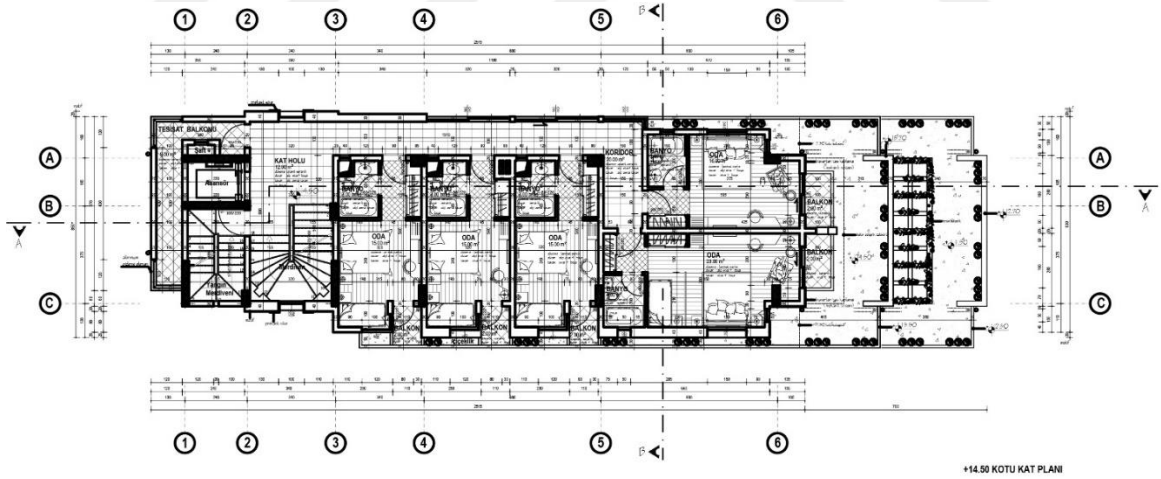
Volkii Hotel 1. ve 2. kat planı
